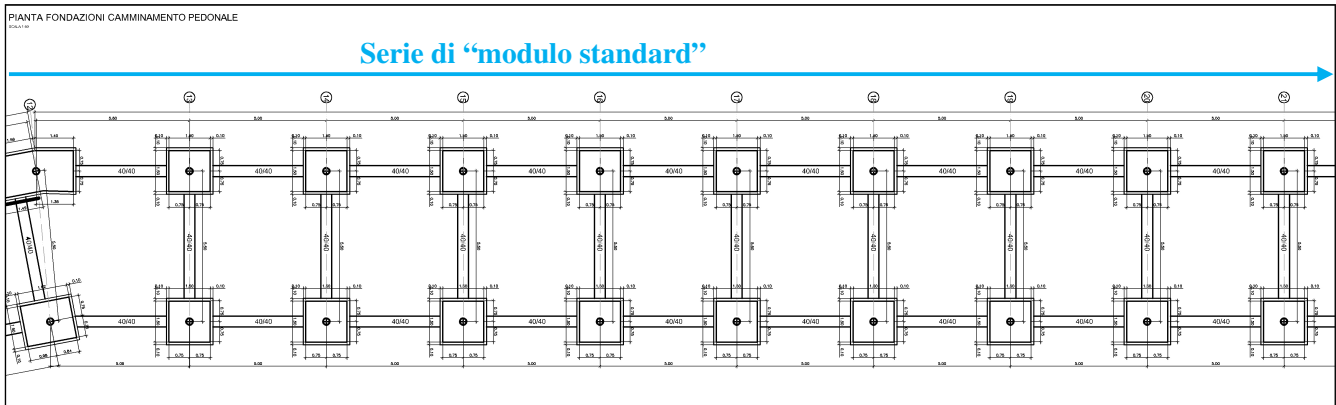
Estratto pianta delle fondazioni del Camminamento pedonale
